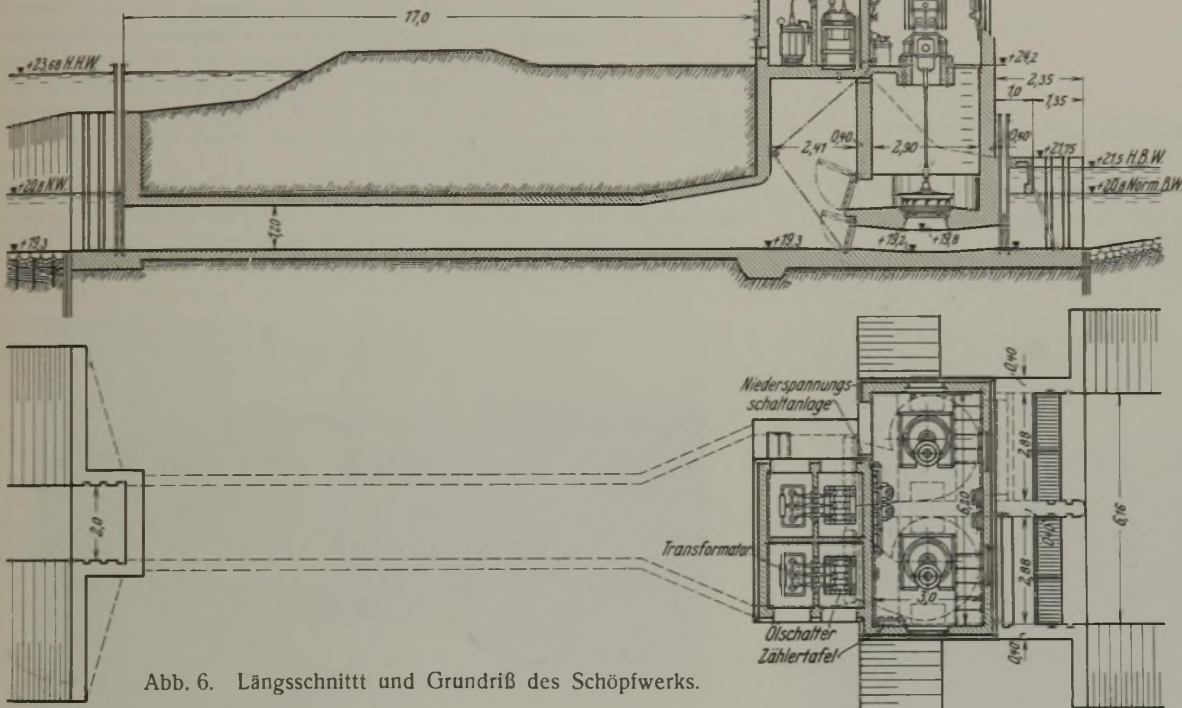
Längsschnitt und Grundriß des Schöpfwerks.
